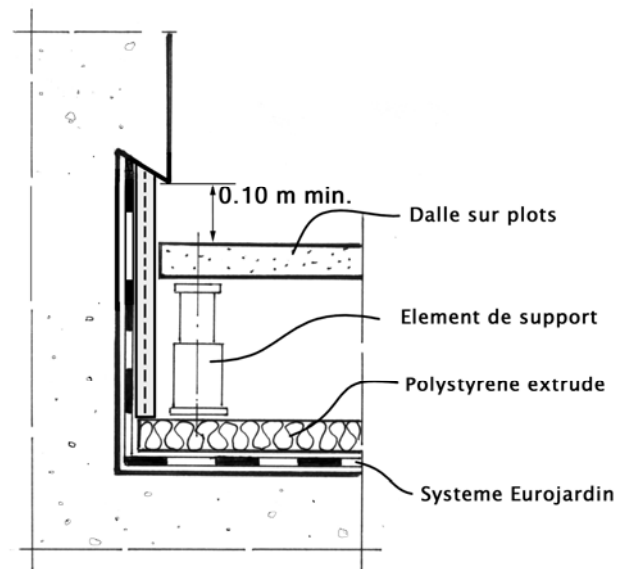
E – Relevé sur terrasses accessibles par dalles sur plots, autre cas de l'isolation inversée
